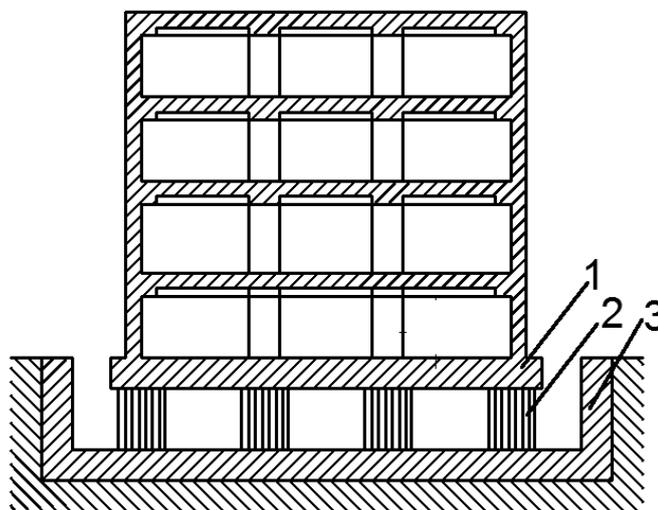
Здание с гибким нижним этажом (1 – надземная часть здания; 2 – гибкие опорные элементы; 3 – подземная часть здания)
